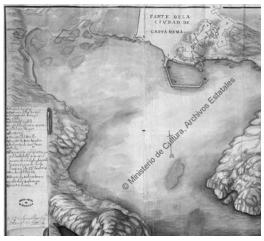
Plano del proyecto para la construcción de un puerto para la Escuadra de Galeras. (Ministerio de Cultura. Archivo General de Simancas)
